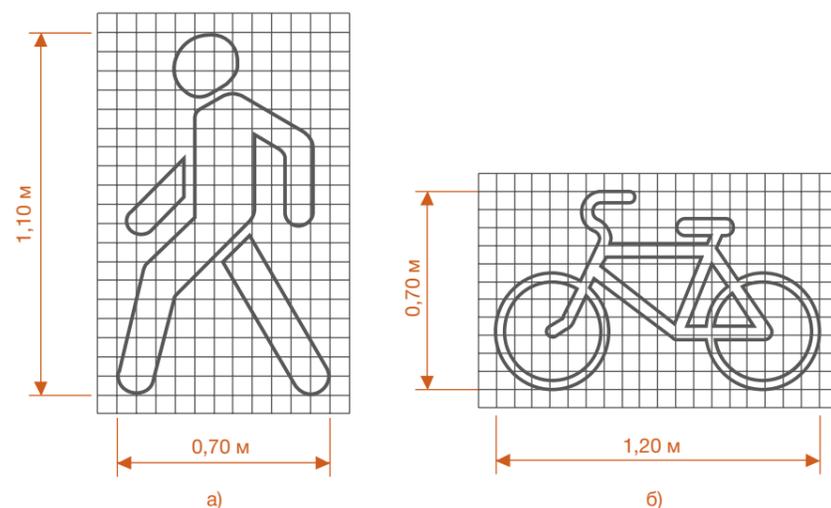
Размеры разметки 1.23.2 и 1.23.3
